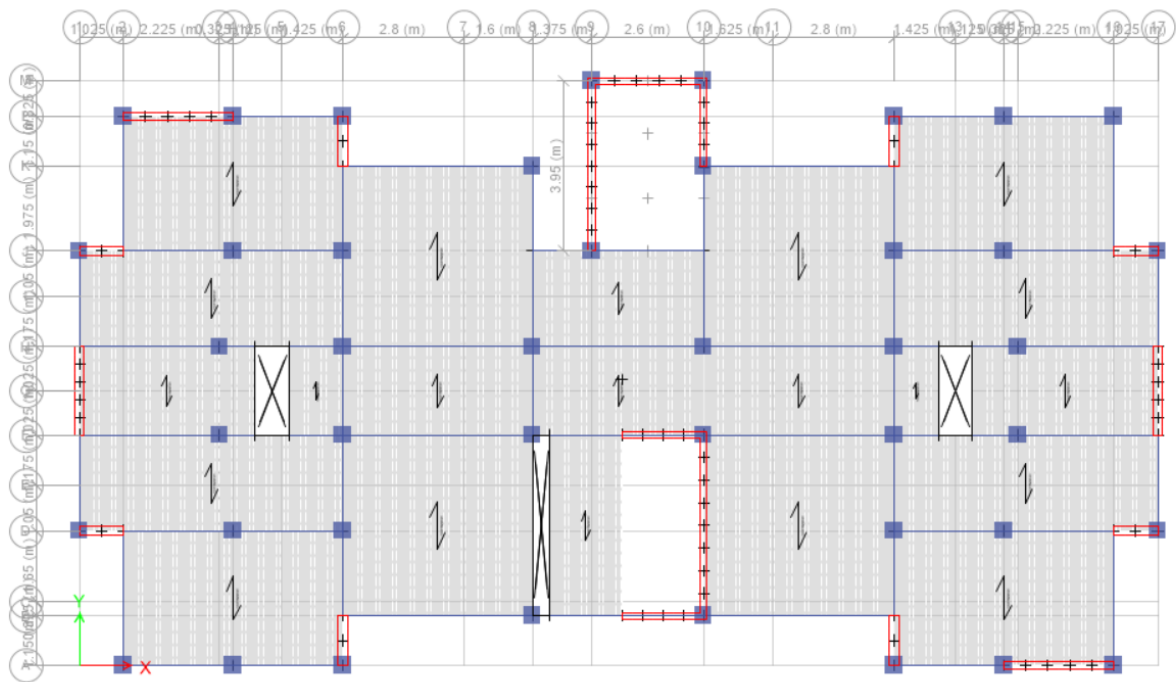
Disposición de elementos estructurales (Planta típica) Sistema Dual - Edificio Blesser. Fuente: Elaboración Propia.
